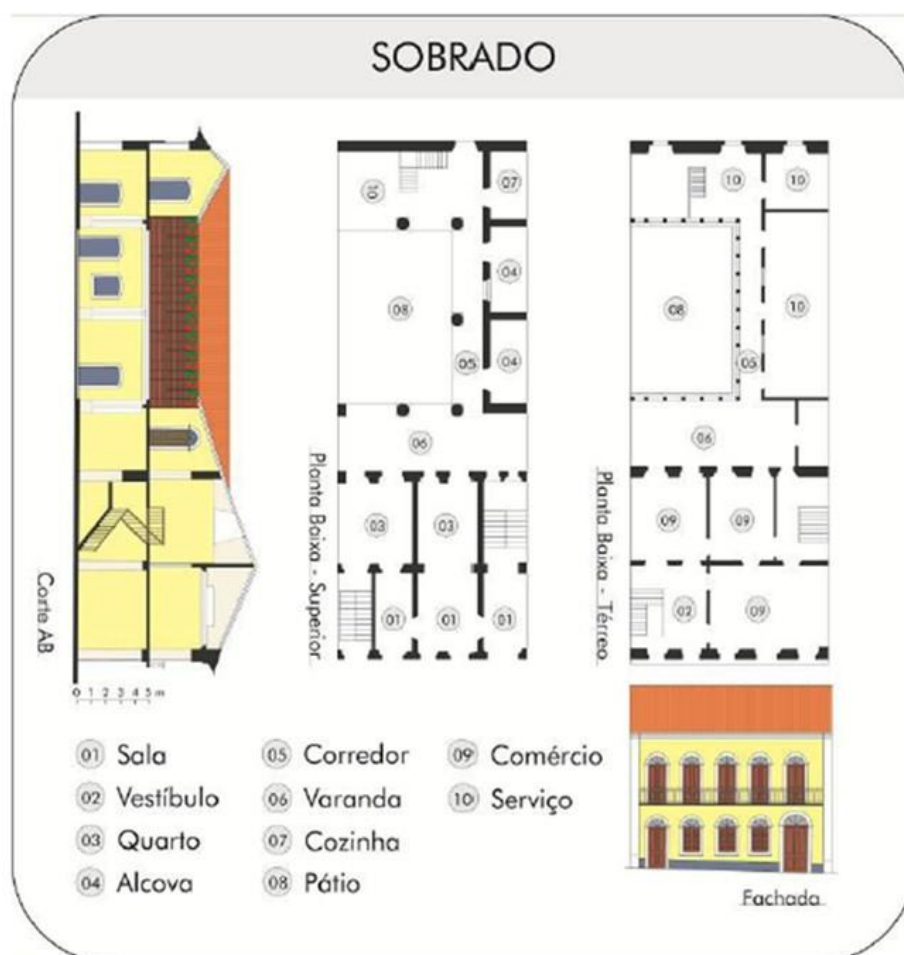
Desenhos esquemáticos do Sobrado (corte, fachada e plantas baixas). Fonte: Figueiredo, 2014: 51, adaptado de Silva Filho, 1998 (1986).
